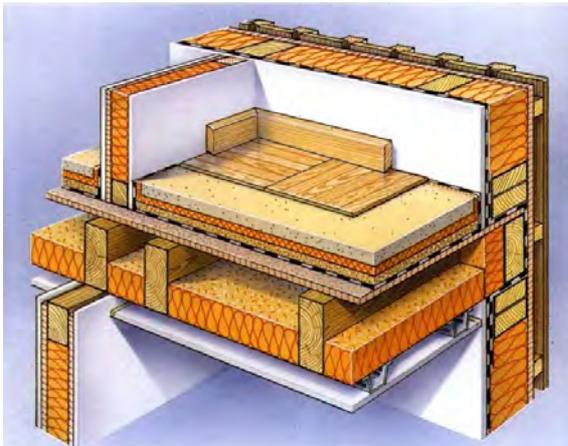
Beispiel mehrschalige Holzbalkendecke aus "Schalldämmende Holzbalkendecken", Holzbauhandbuch
